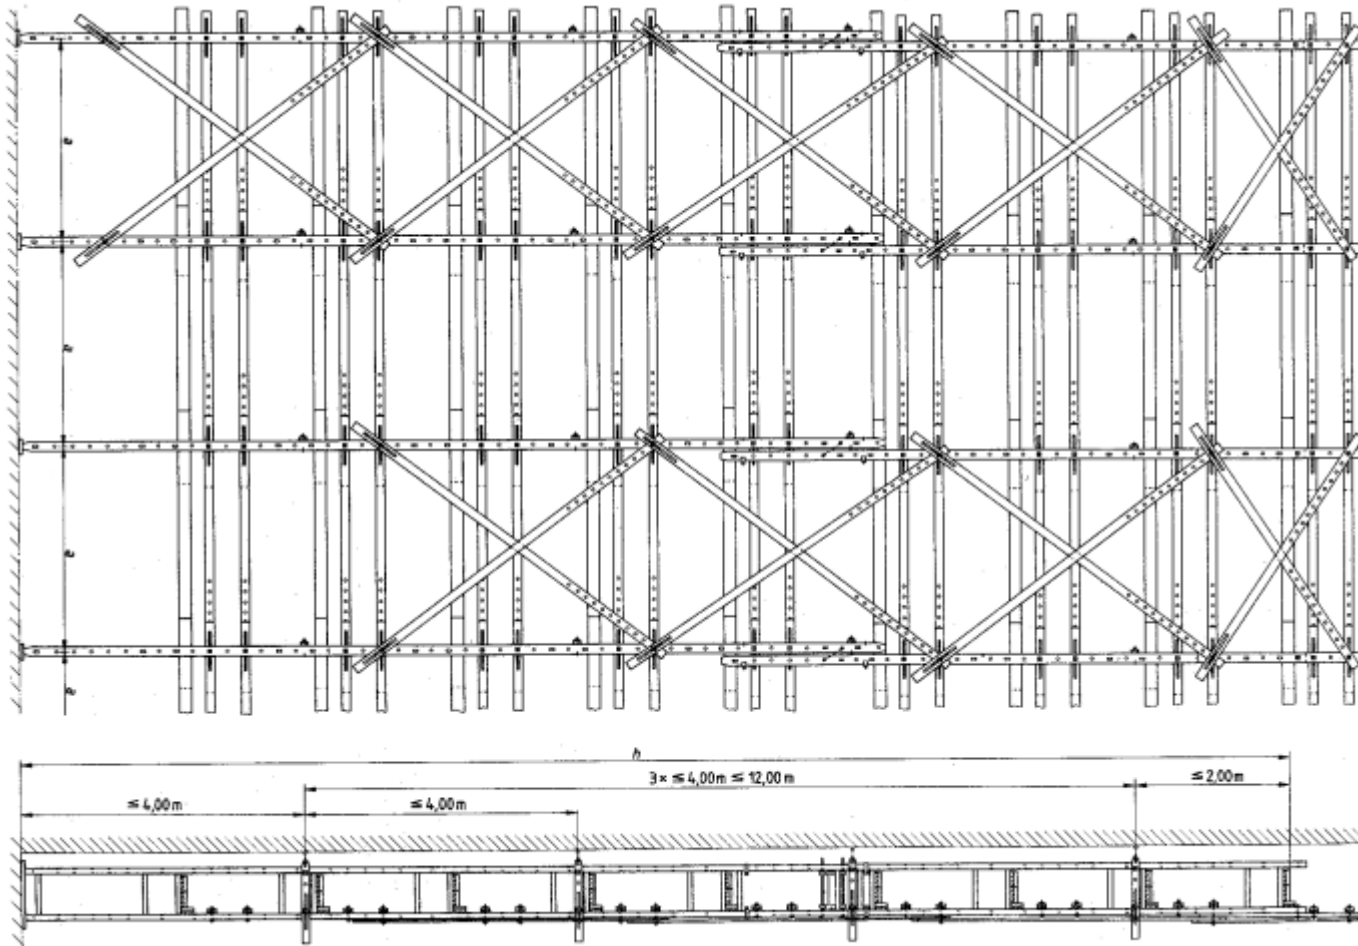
Fassadengerüst (zulässige Gerüstfeldlänge zu a , siehe Tabelle 5, zulässige Gerüsthöhen zu h , siehe Abschnitt 5.1.1 und Belagbreiten siehe Abschnitt 5.1.3)
